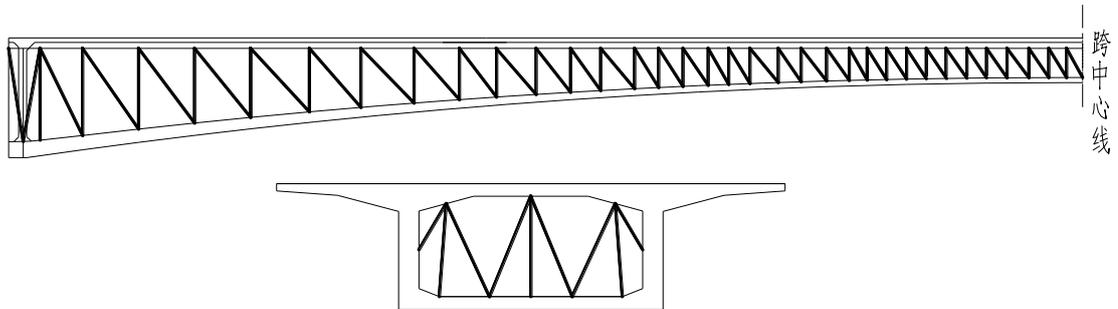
钢桁架加固箱梁的纵横向布置示意
